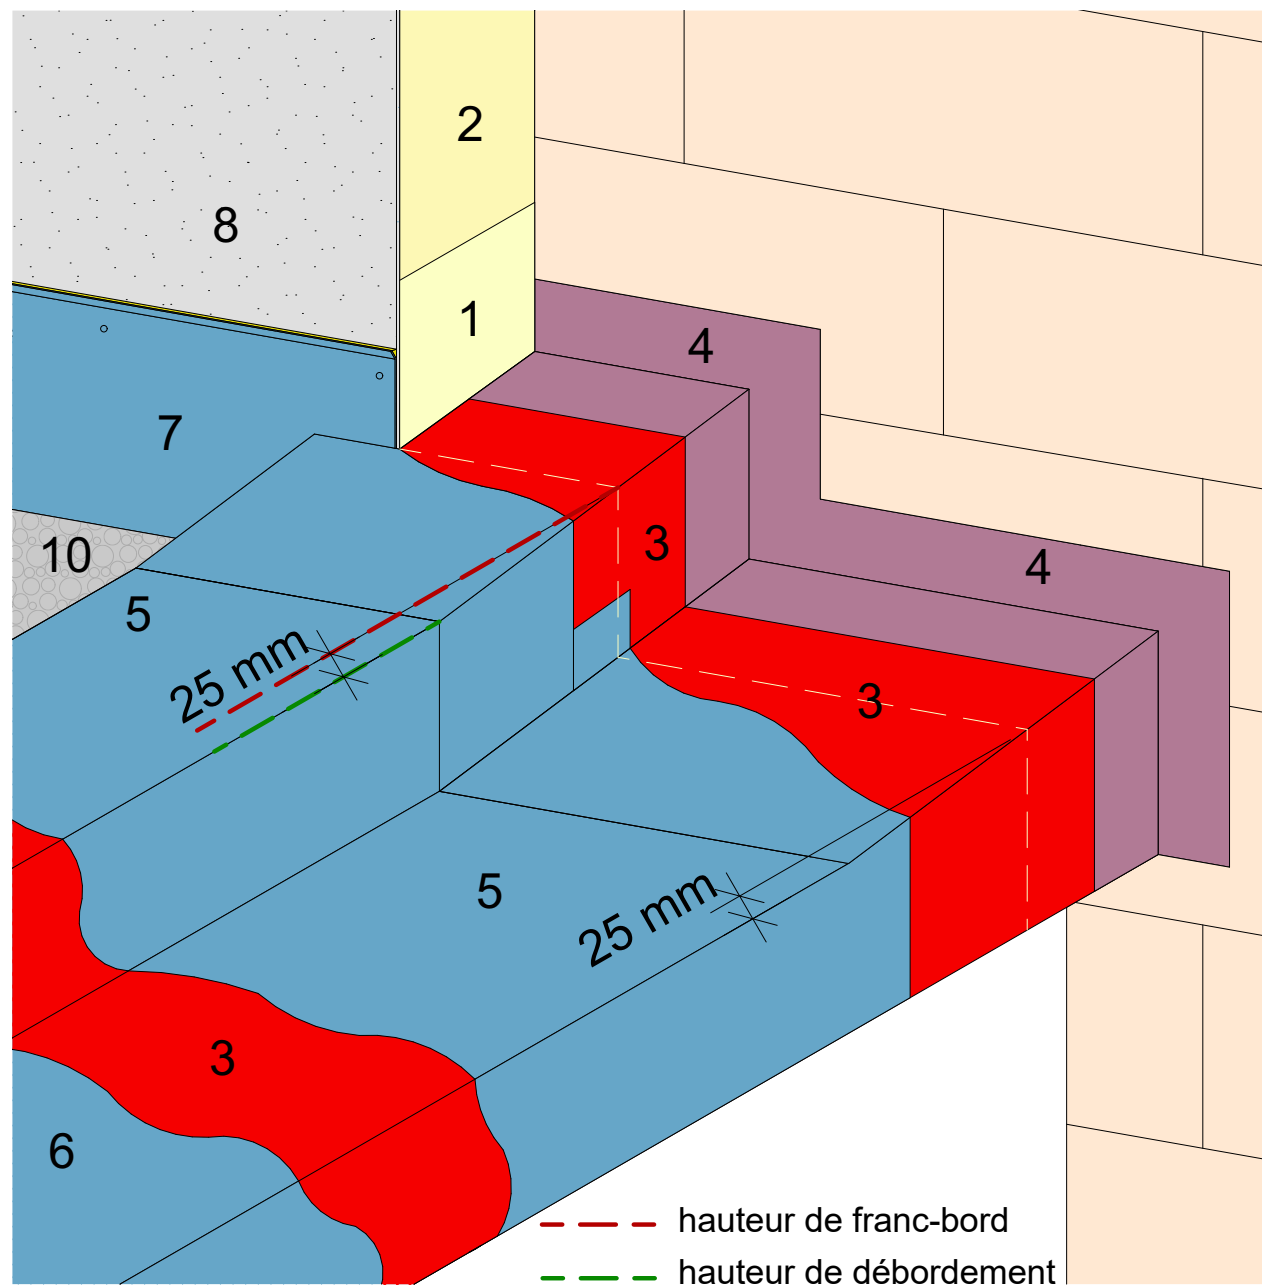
Raccordement au mur Variante 3 (exemple 3)
